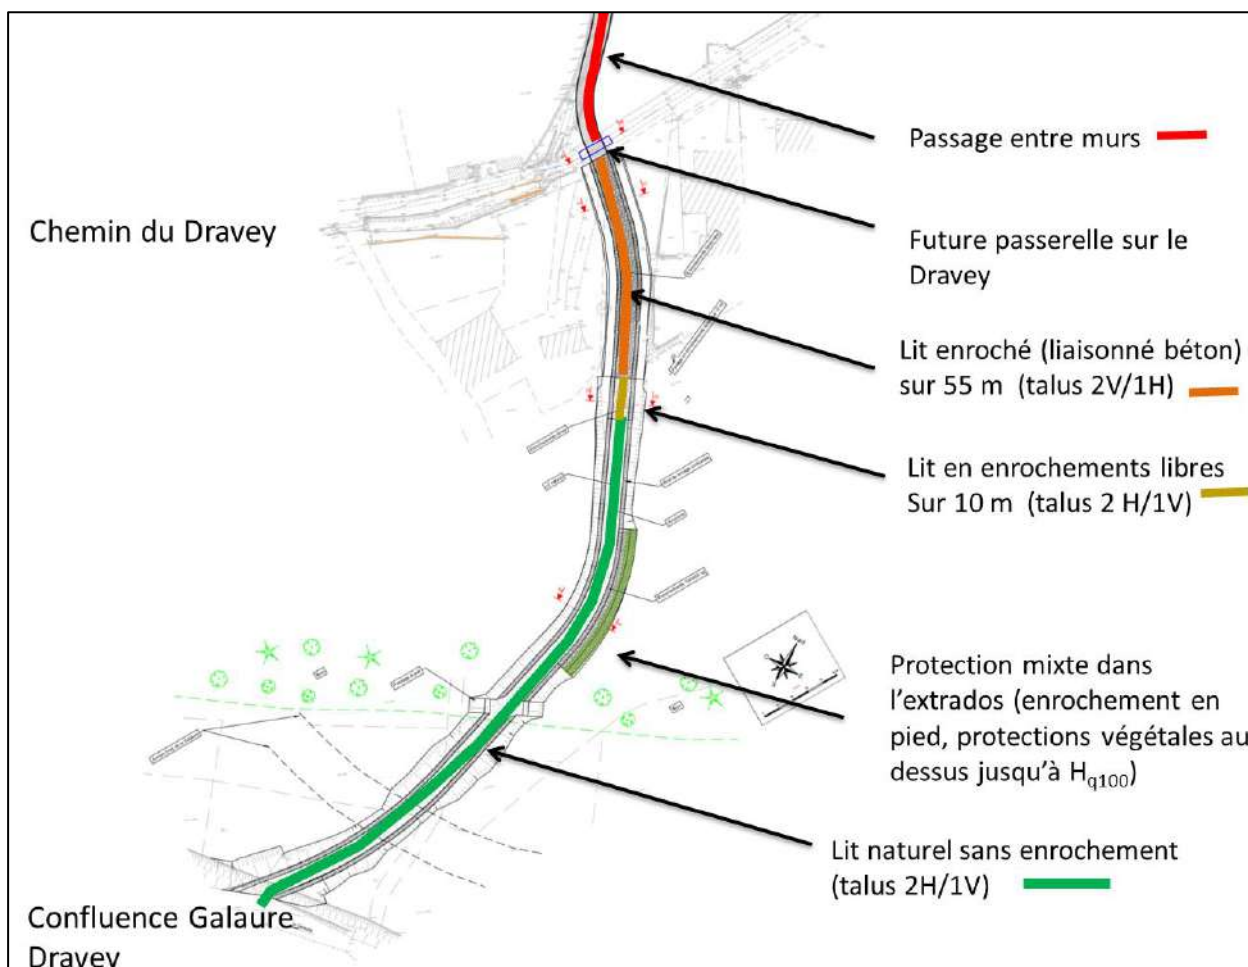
Plan des différents secteurs du nouveau lit du Dravey.
